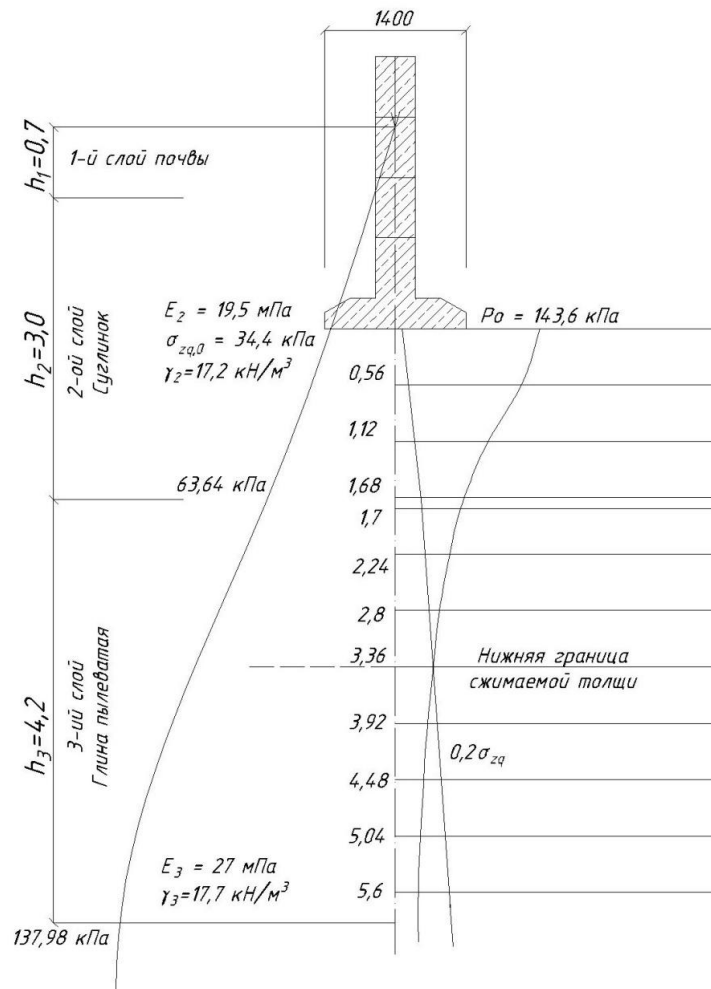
Расчетная схема осадки ленточного фундамента второго типа
